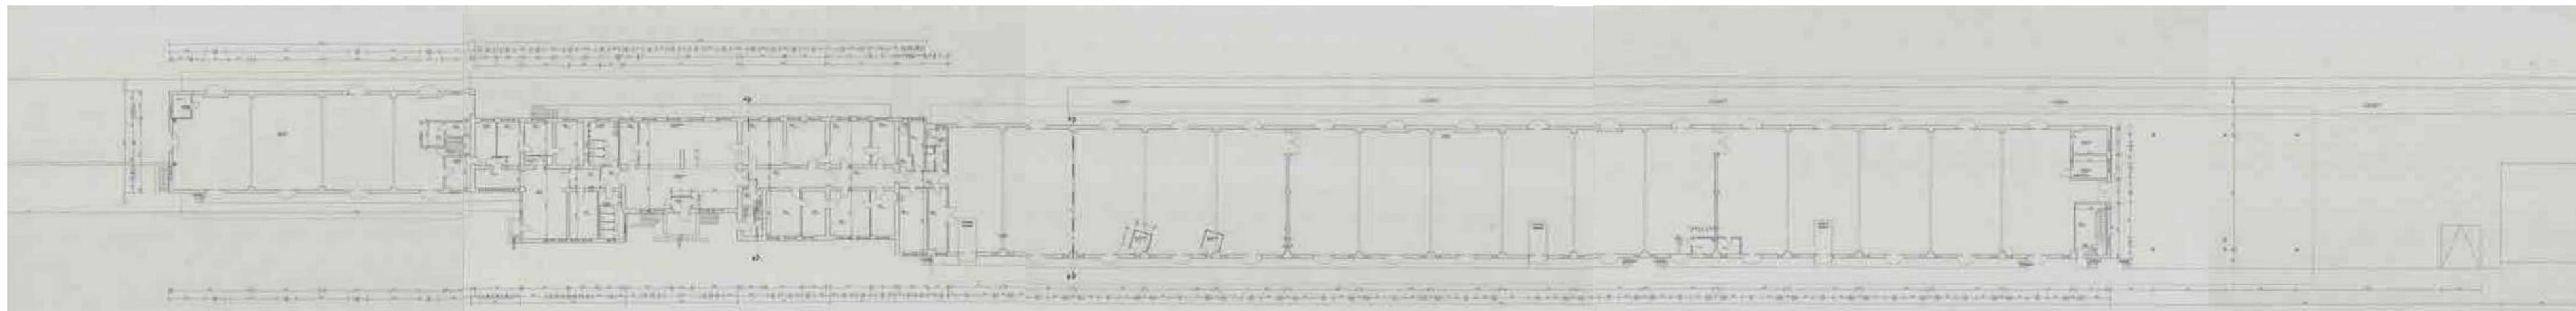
Gesamtanlage: Plan mit Grundriss des Erdgeschosses der Gesamtanlage ohne die Zollräumlichkeiten im Süden, 1998
